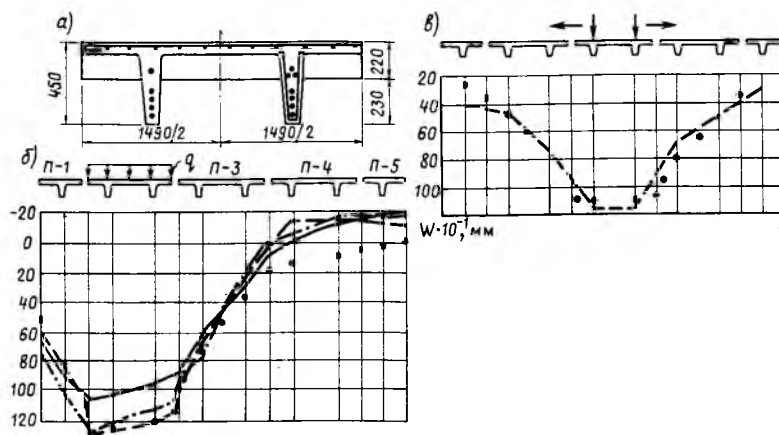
Испытание перекрытия из легких плит 2Т пролетом 12 м
